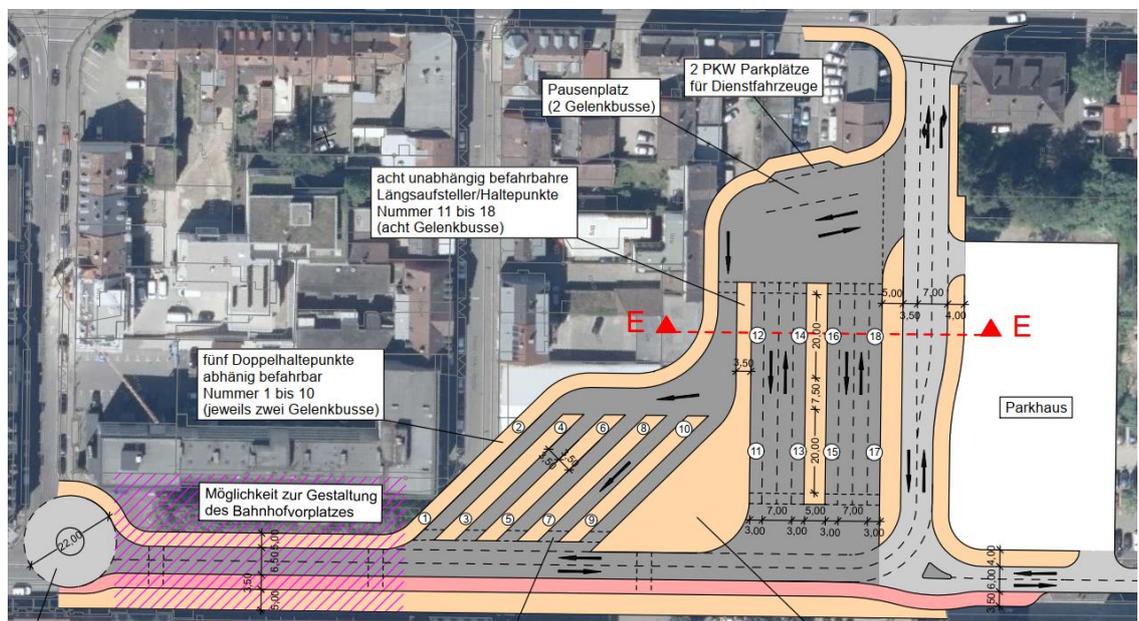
Ausschnitt Lageplan Nordverlegung 4
